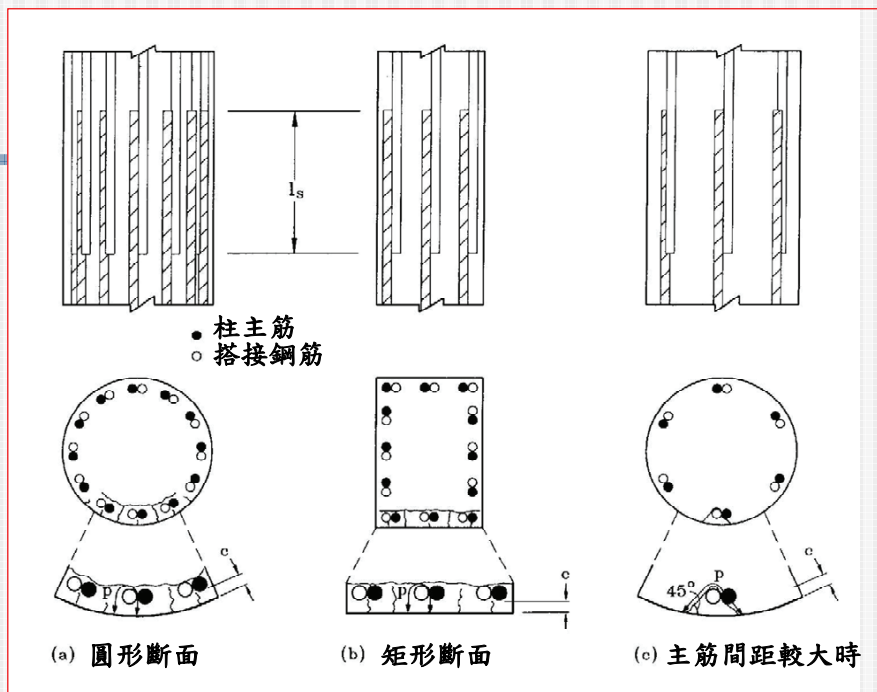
柱搭接鋼筋混凝土之劈裂
